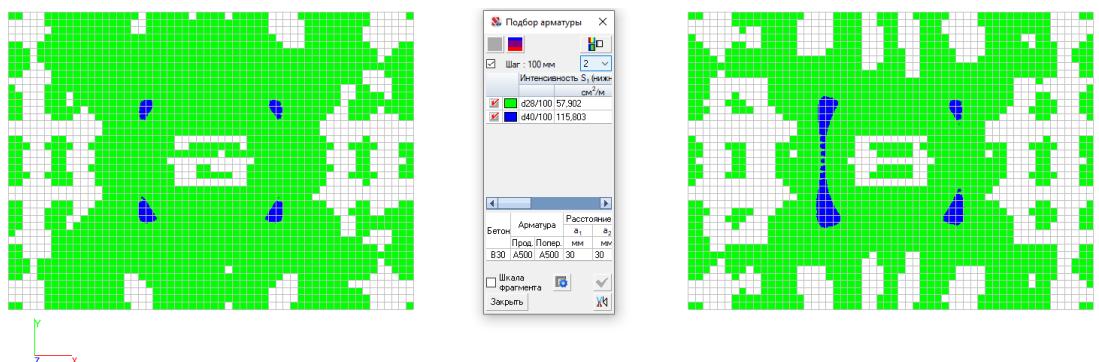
Интенсивность нижнего армирования фундаментной плиты по ОХ
